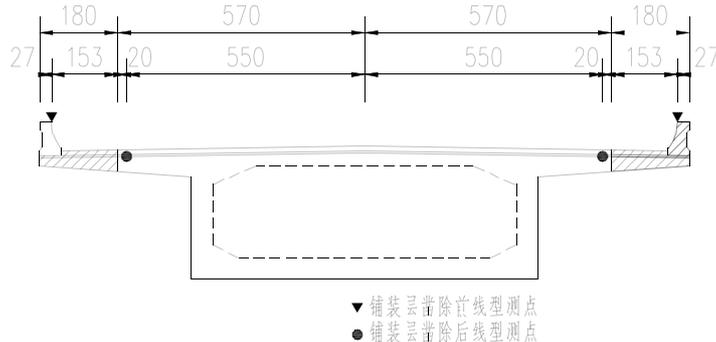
主梁线形测点横向布置图 (单位: cm)
